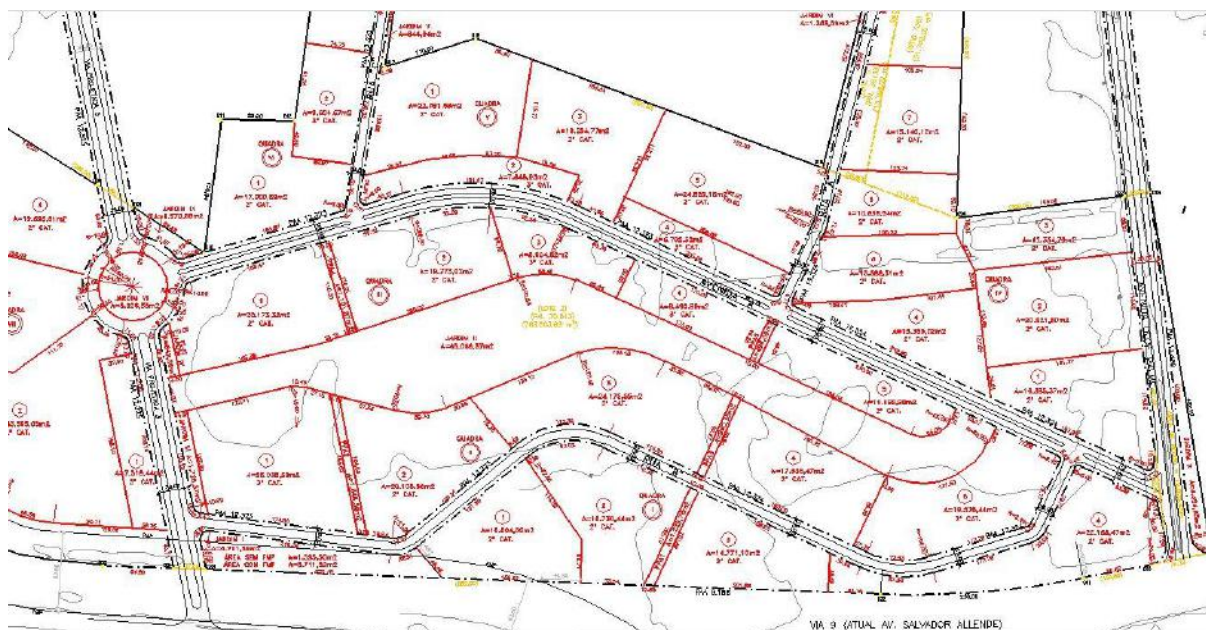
Trecho do PAL 47972 de 11/04/2012 do “Bairro Planejado” Ilha Pura, em Camorim.
